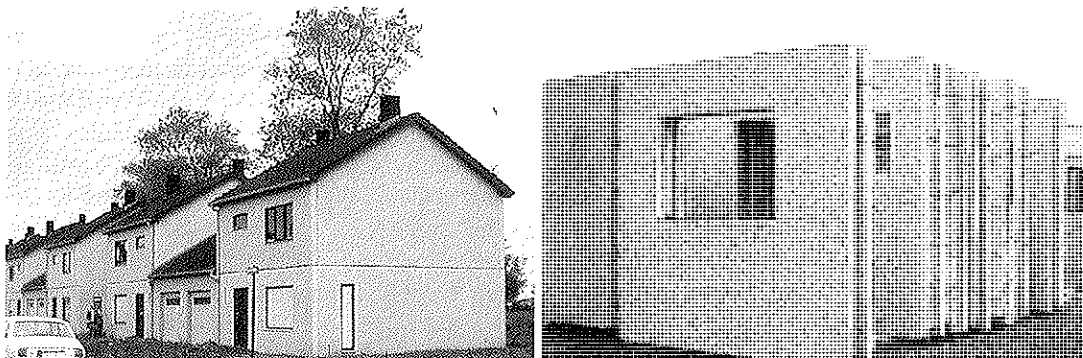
Viviendas prefabricadas con hormigón con fibras de acero en Bélgica.
